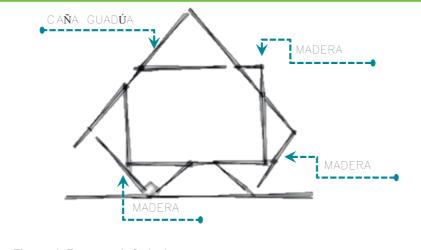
Esquema de fachada. Fuente. Al borde, 2014.
